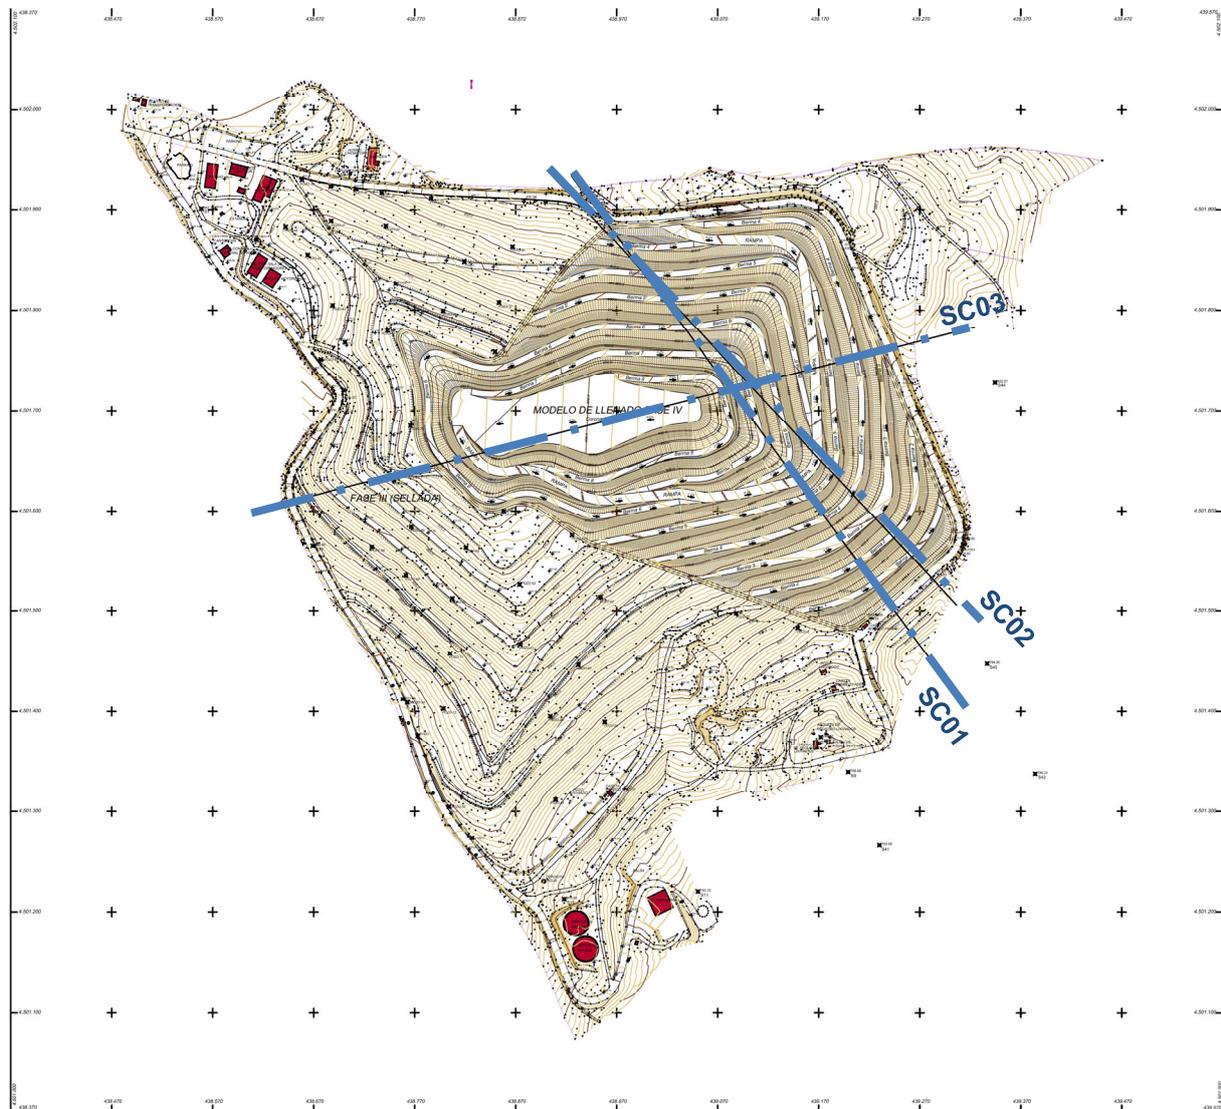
Planta de ubicación de Perfiles considerados en el calculo
